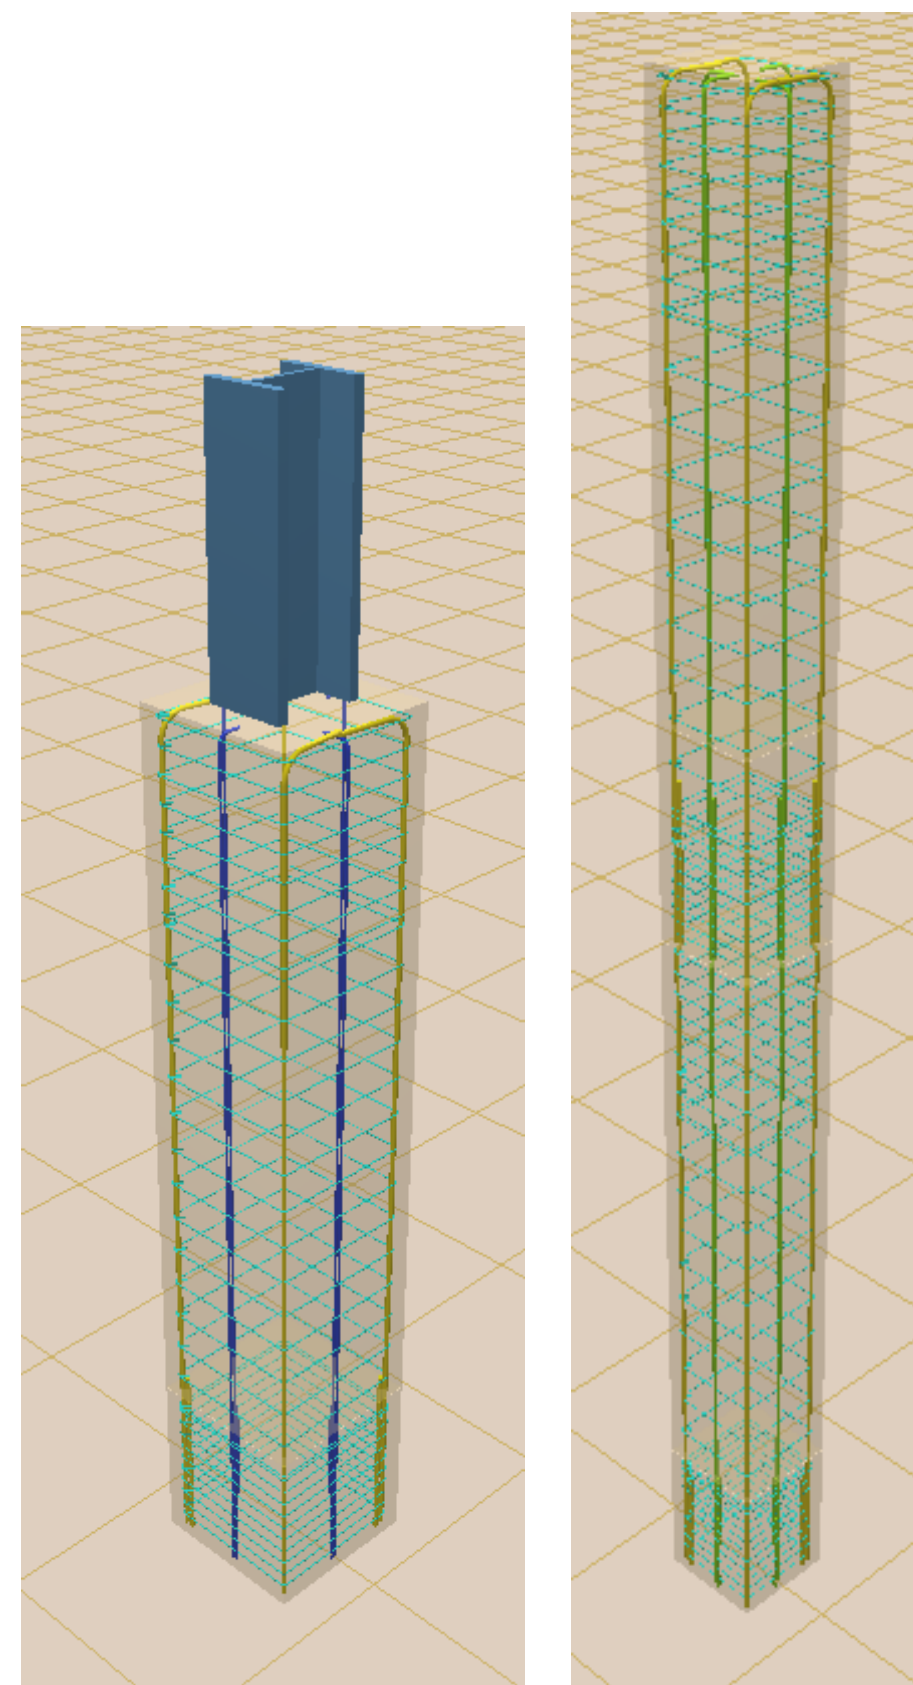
Detalle 3D de las agrupaciones 3 y 4. Fuente: Propia
